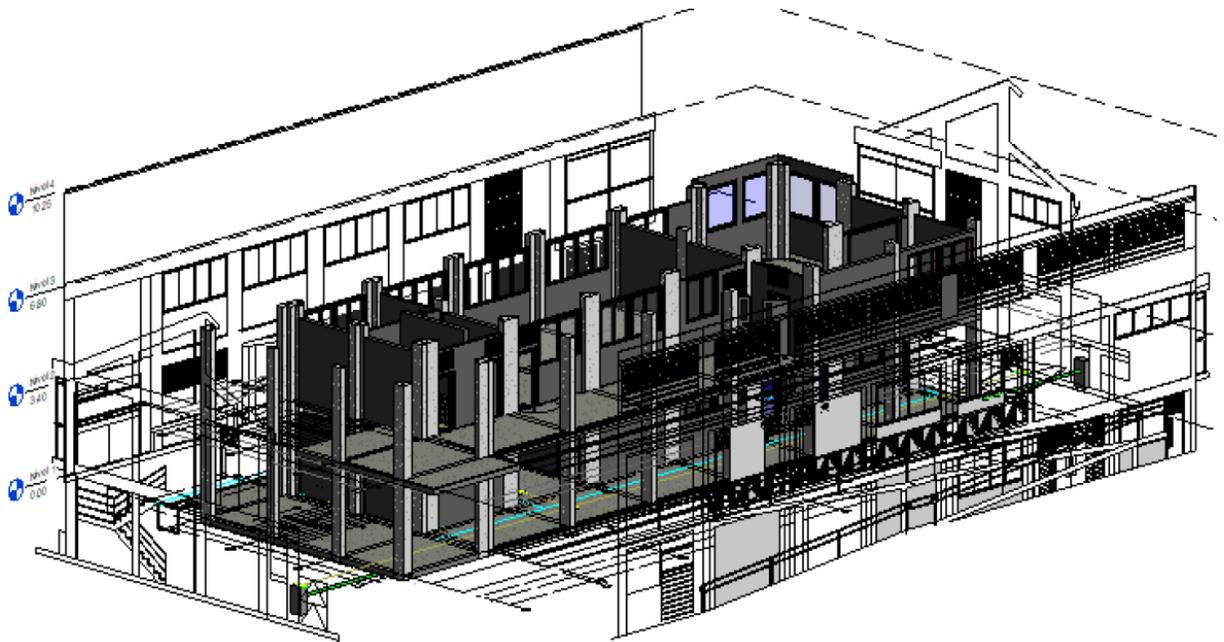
Modelado Arquitectónico muros puertas y ventanas (REVIT)
